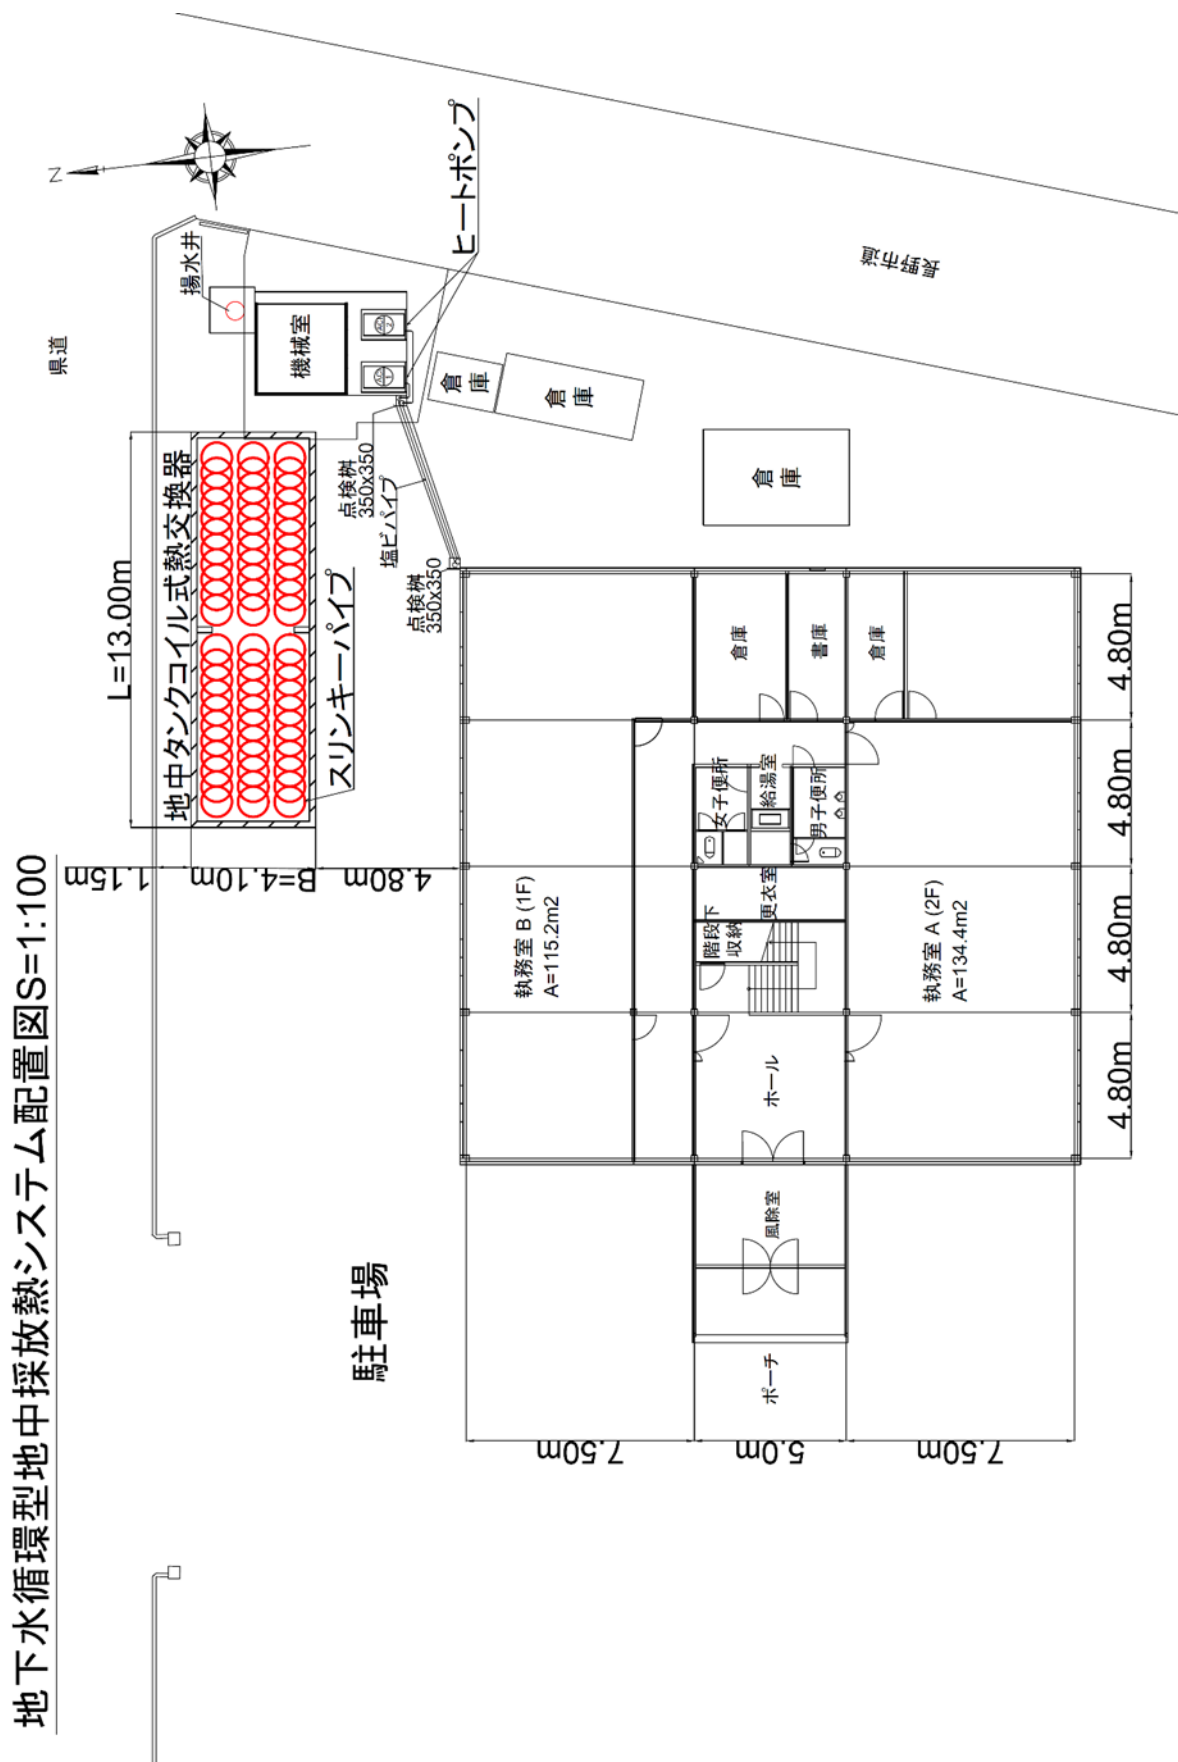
地下水循環型地中採放熱システムと空調対象建物の配置平面図
